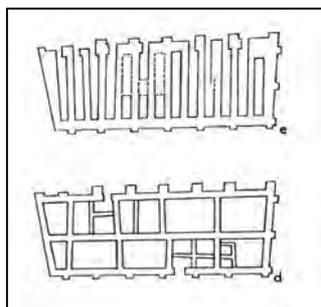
Telul eth-Thalathat/ED II-Zeit, Speichergebäude, Grundriss und Grillplan-Fundamente (Hole 1991:fig.3d-e)
